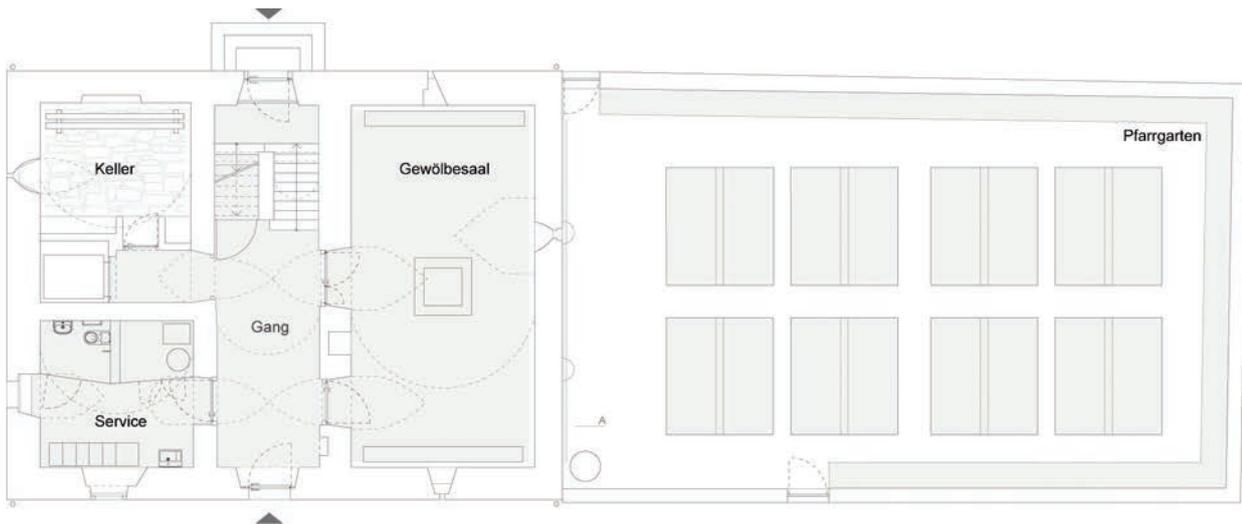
Pfarrhaus, Grundriss Erdgeschoss.
